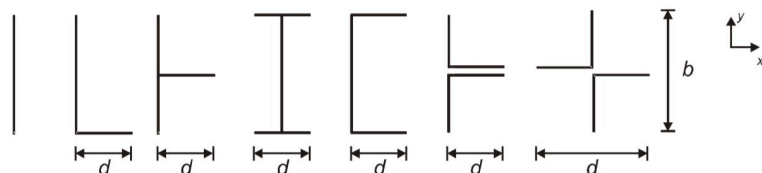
Elementos estruturais de secção com arestas vivas (LNEC 2010)
